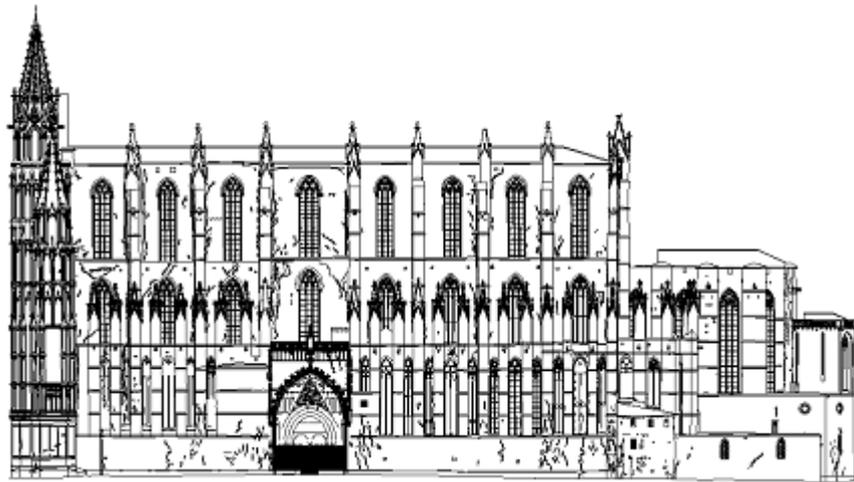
Patrón de fisuración existente en la fachada sur
